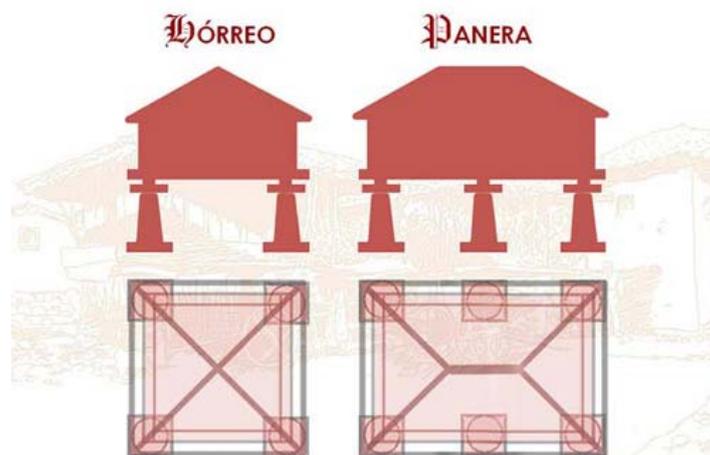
Diferencias de planta y alzado entre hórreos y paneras.
